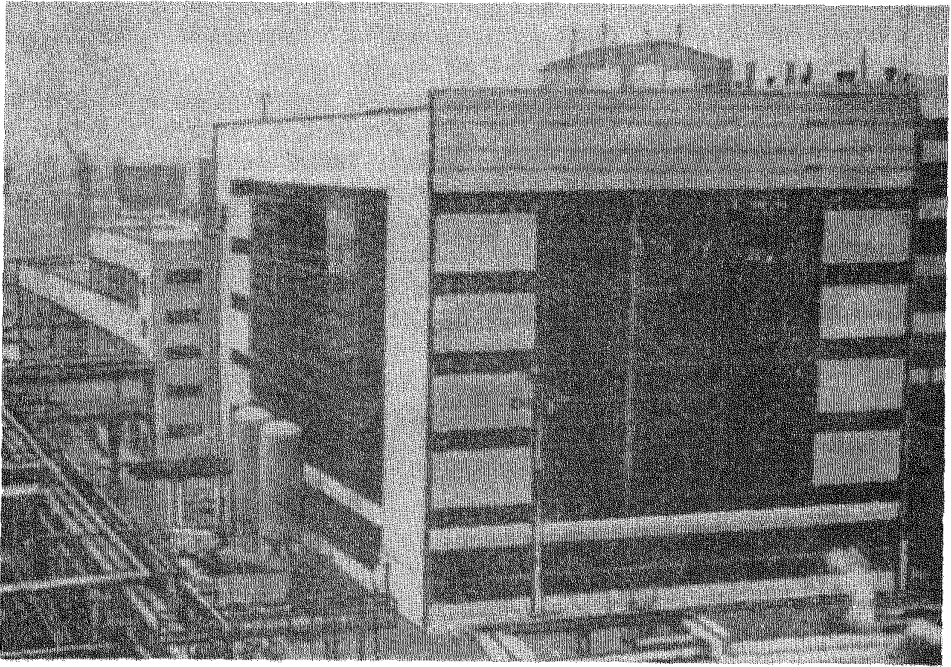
Одноэтажные производственные здания с "открытым" фасадом
